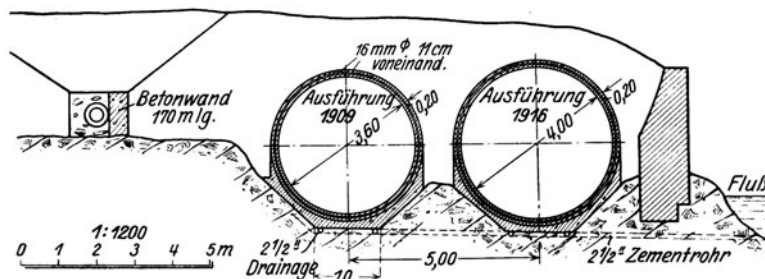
Elverum. Eisenbetondruckleitung. (Verw.)
